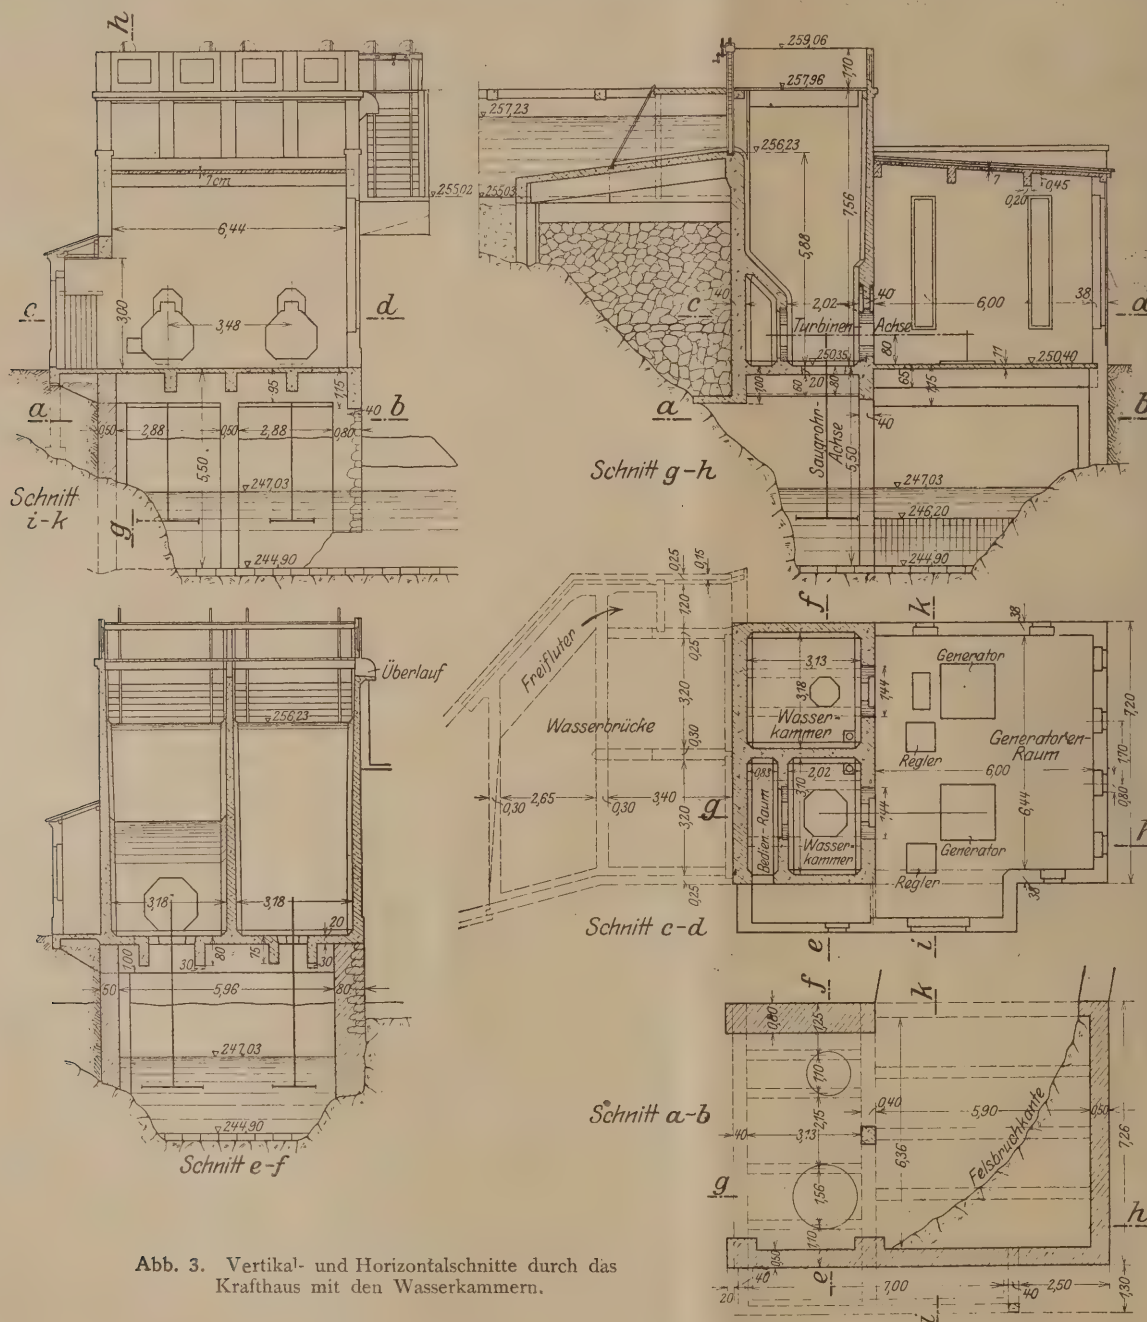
Vertikal- und Horizontalschnitte durch das Krafthaus mit den Wasserkammern.
